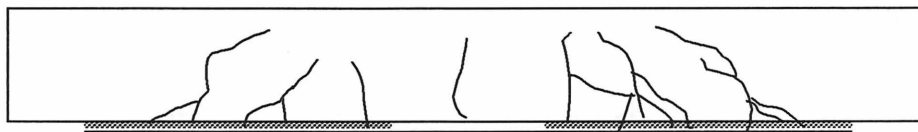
Réseau de fissuration d'une poutre typique renforcée de Carbodur S (P13-Sika-A)
